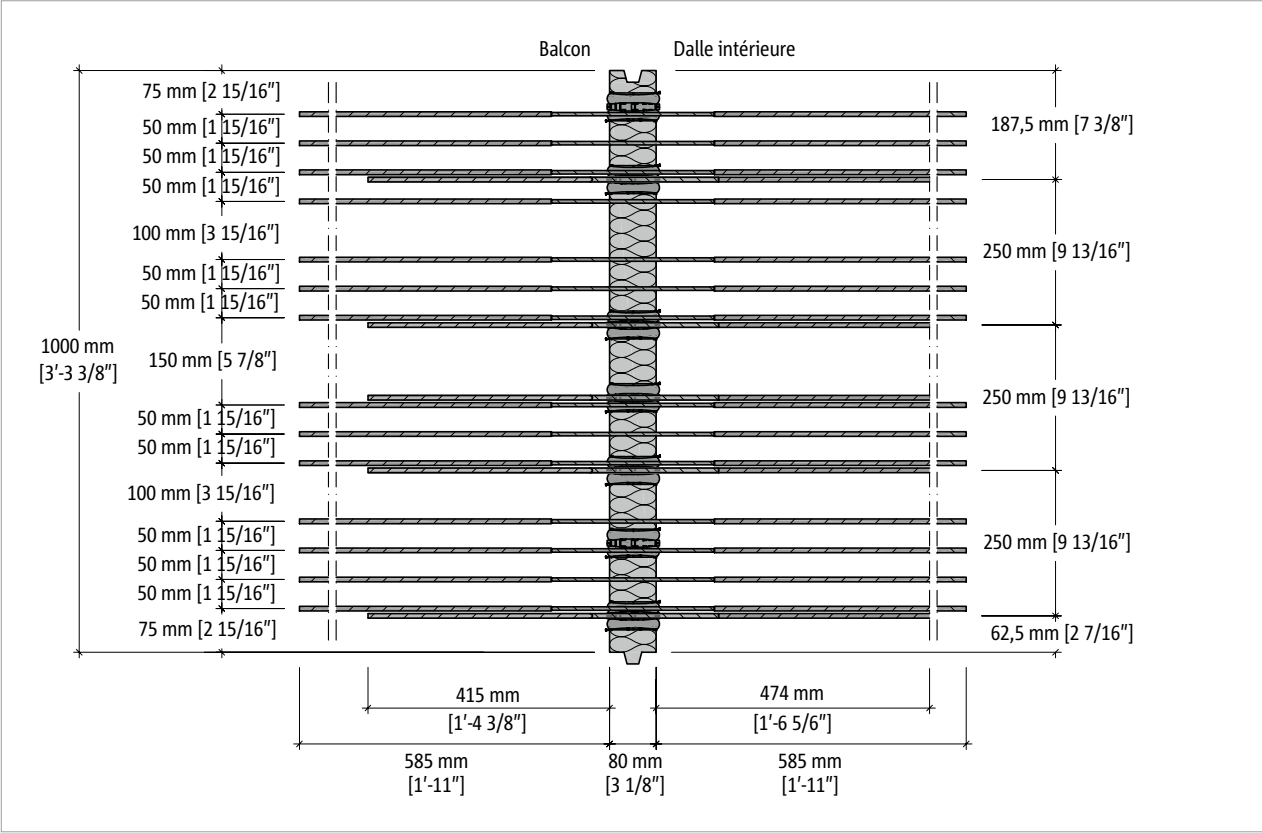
Schöck Isokorb® T Type CK-M5-V2 : vue en plan du produit
